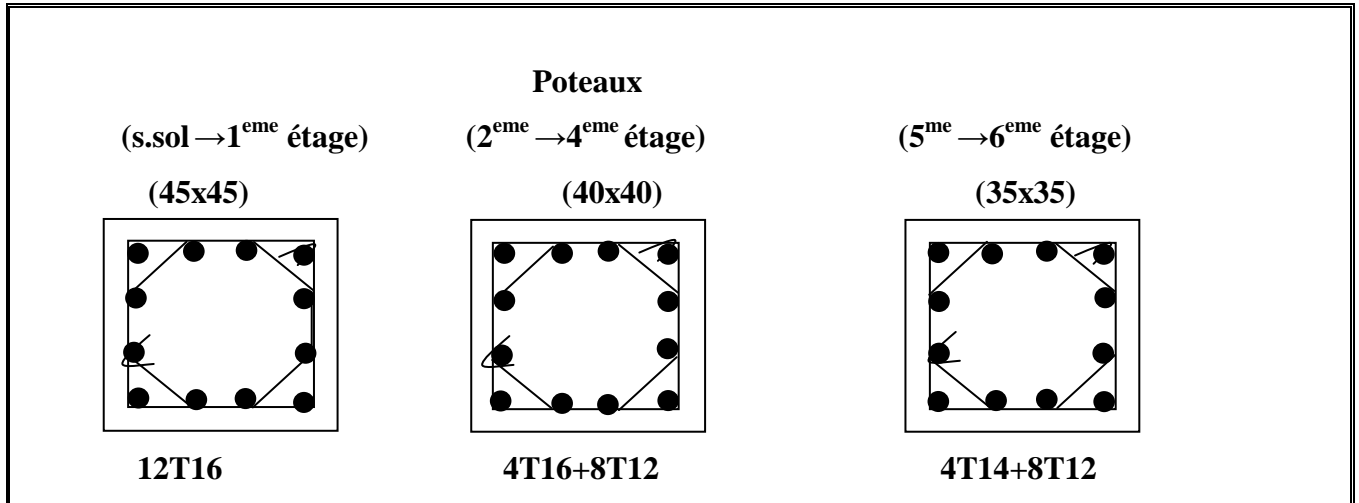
Dessin de ferrillages des sections des poteaux
